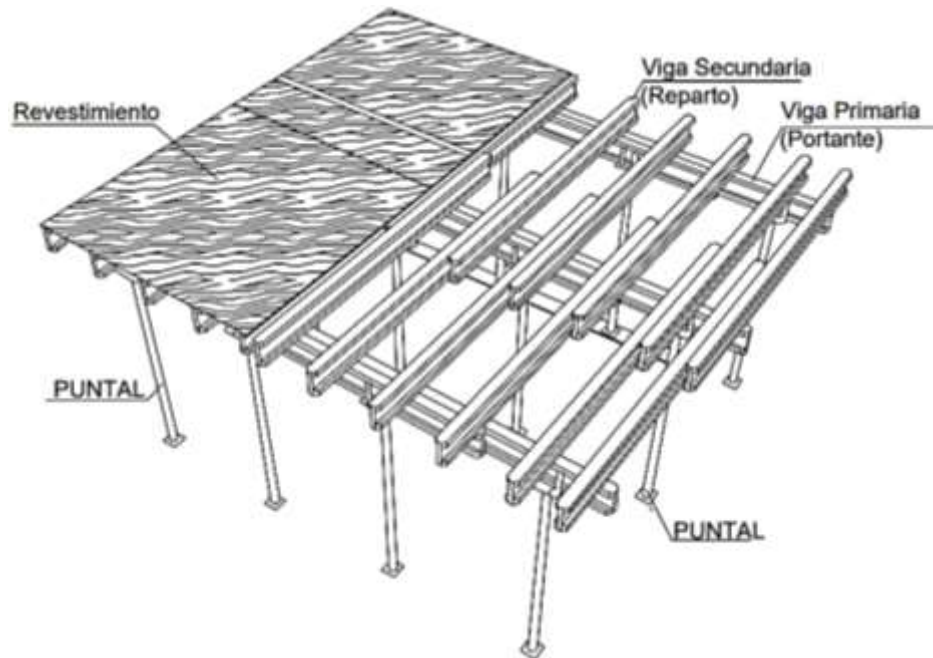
Componentes de un encofrado para losa de concreto. ARRECONSA, (2018)
